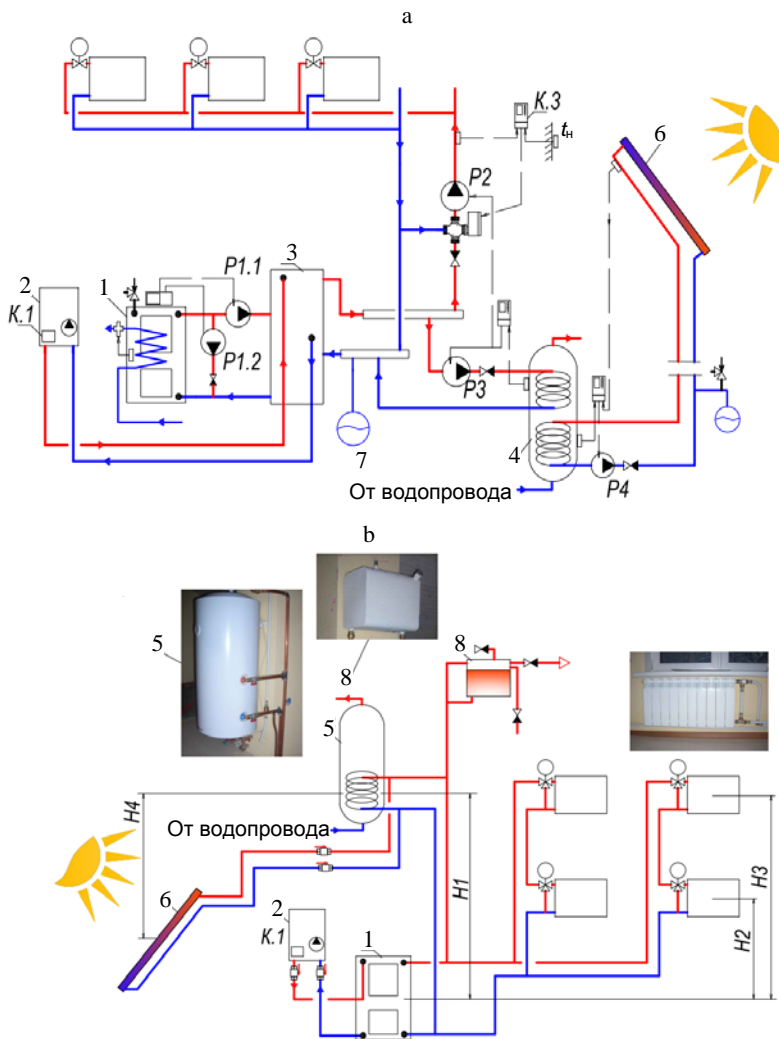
Теплоснабжение жилого дома усадебного типа: а – традиционное проектное решение, применяемое в настоящее время в Европе и Беларуси; б – предлагаемое проектное решение для эксплуатационных условий Беларуси (на схеме фрагментарно показаны фотографии реализованного проекта предлагаемого решения); 1 – дровяной котел; 2 – котел на природном газе; 3 – буферный бак-разделитель; 4, 5 – двухконтурный и одноконтурный бойлер горячего водоснабжения; 6 – гелиоколлектор; 7, 8 – мембранный и «открытый» расширительный бак
